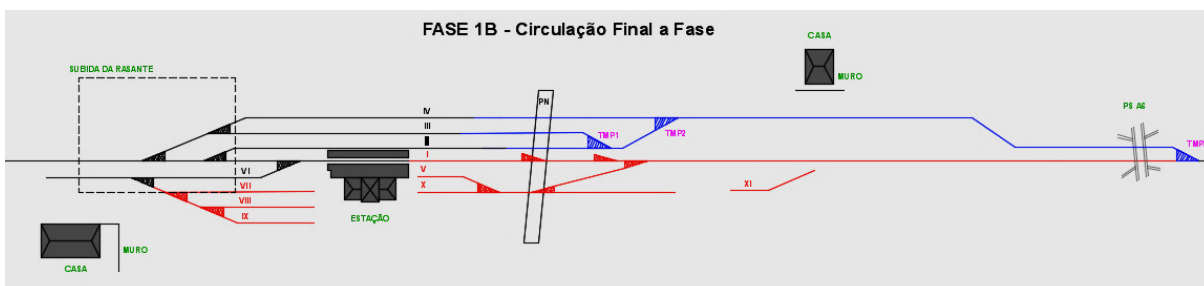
Fase 1B – Levantamento das Linhas I, V, VI, VII, VIII, IX, X e XI
